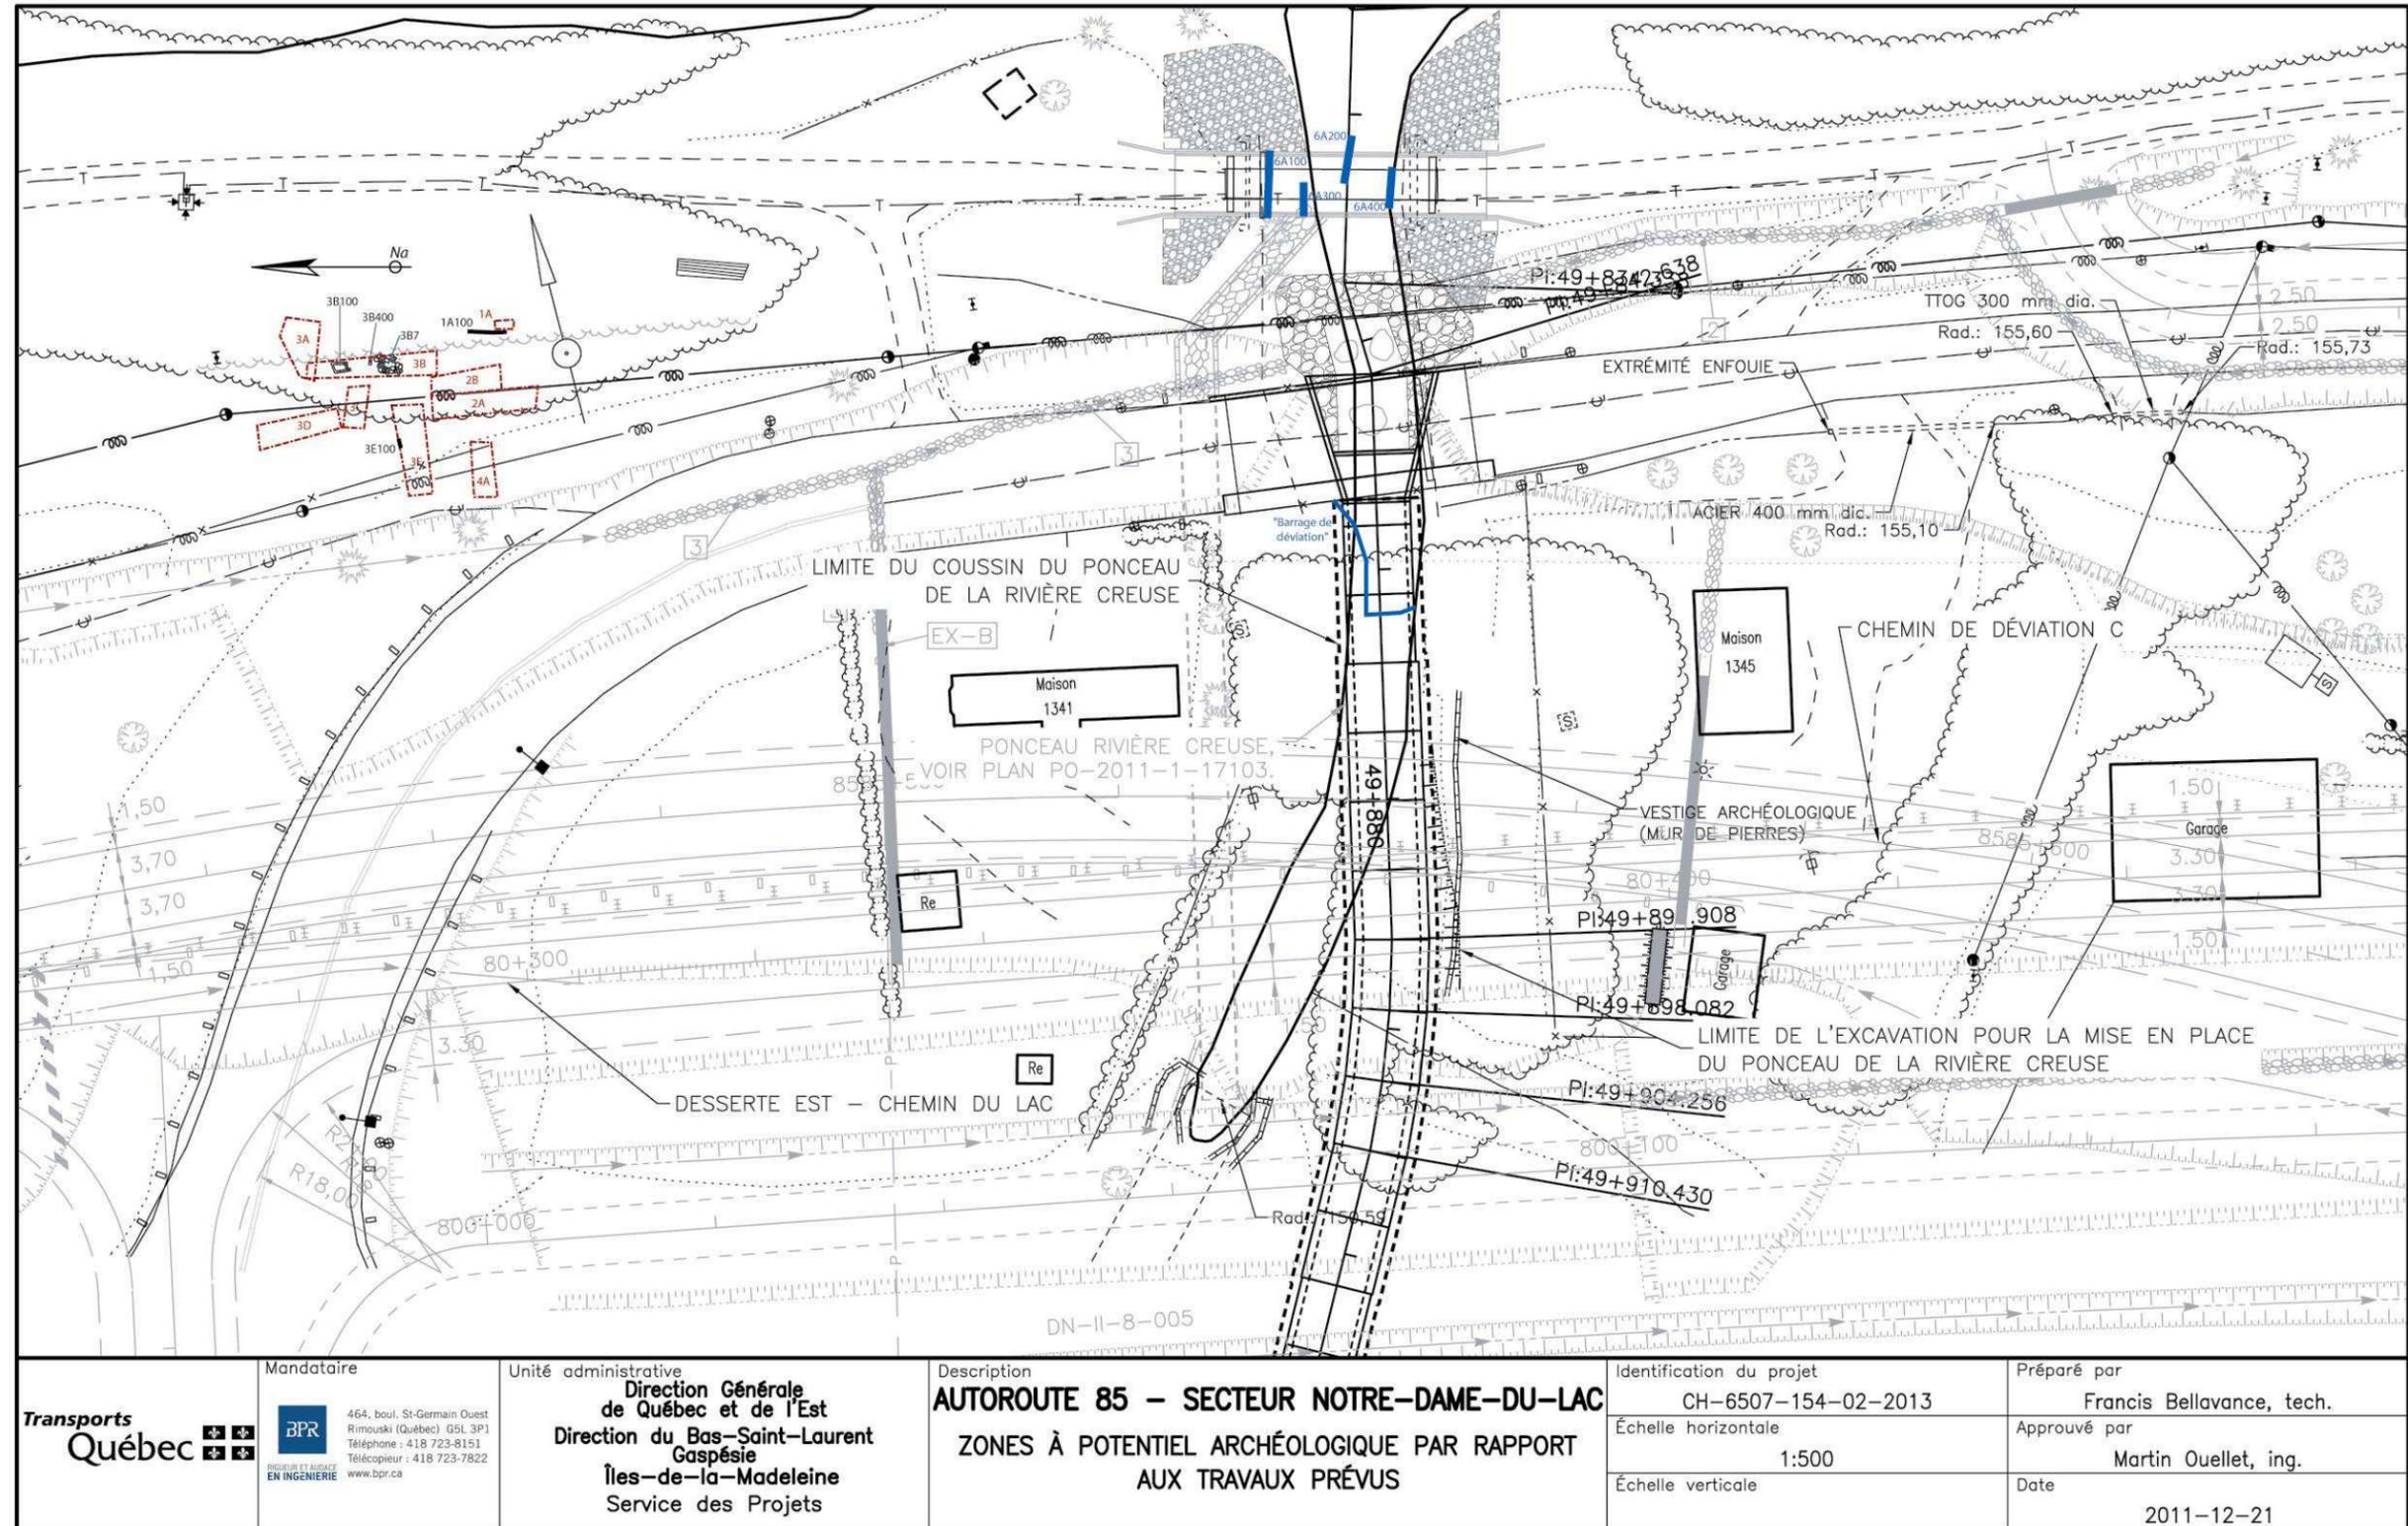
Plan général des sous-opérations du site CjEe-3.
